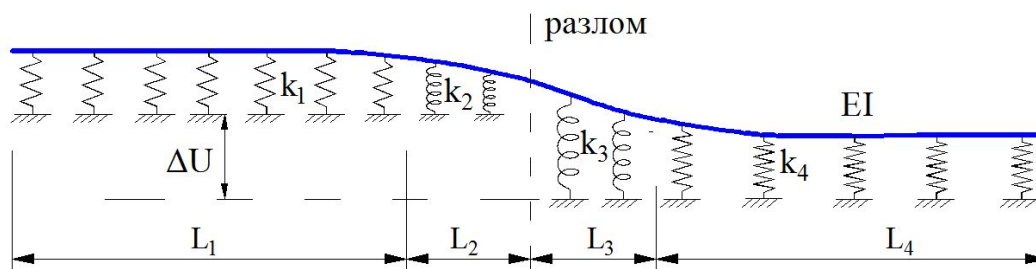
Расчётная схема тоннеля, пересекающего разлом, при наличии упругого слоя
